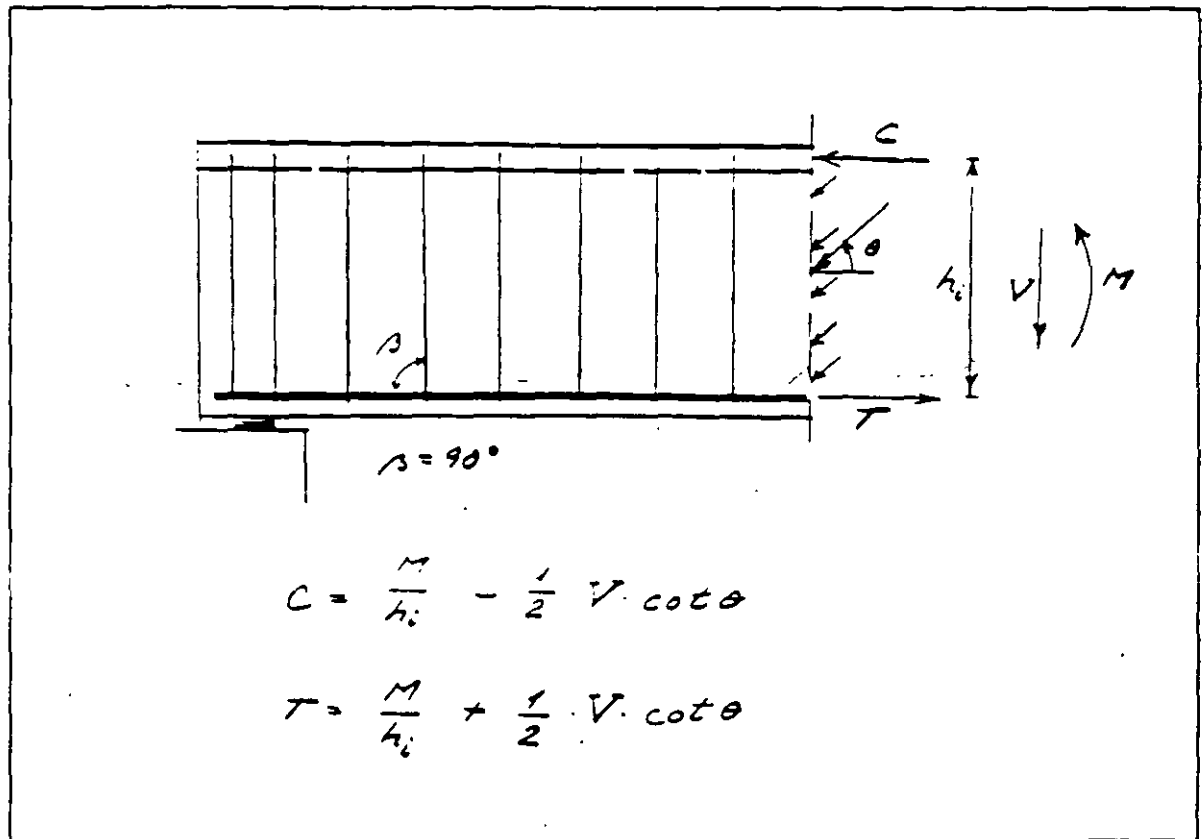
Fuerzas en cuerdas de tensión y compresión
